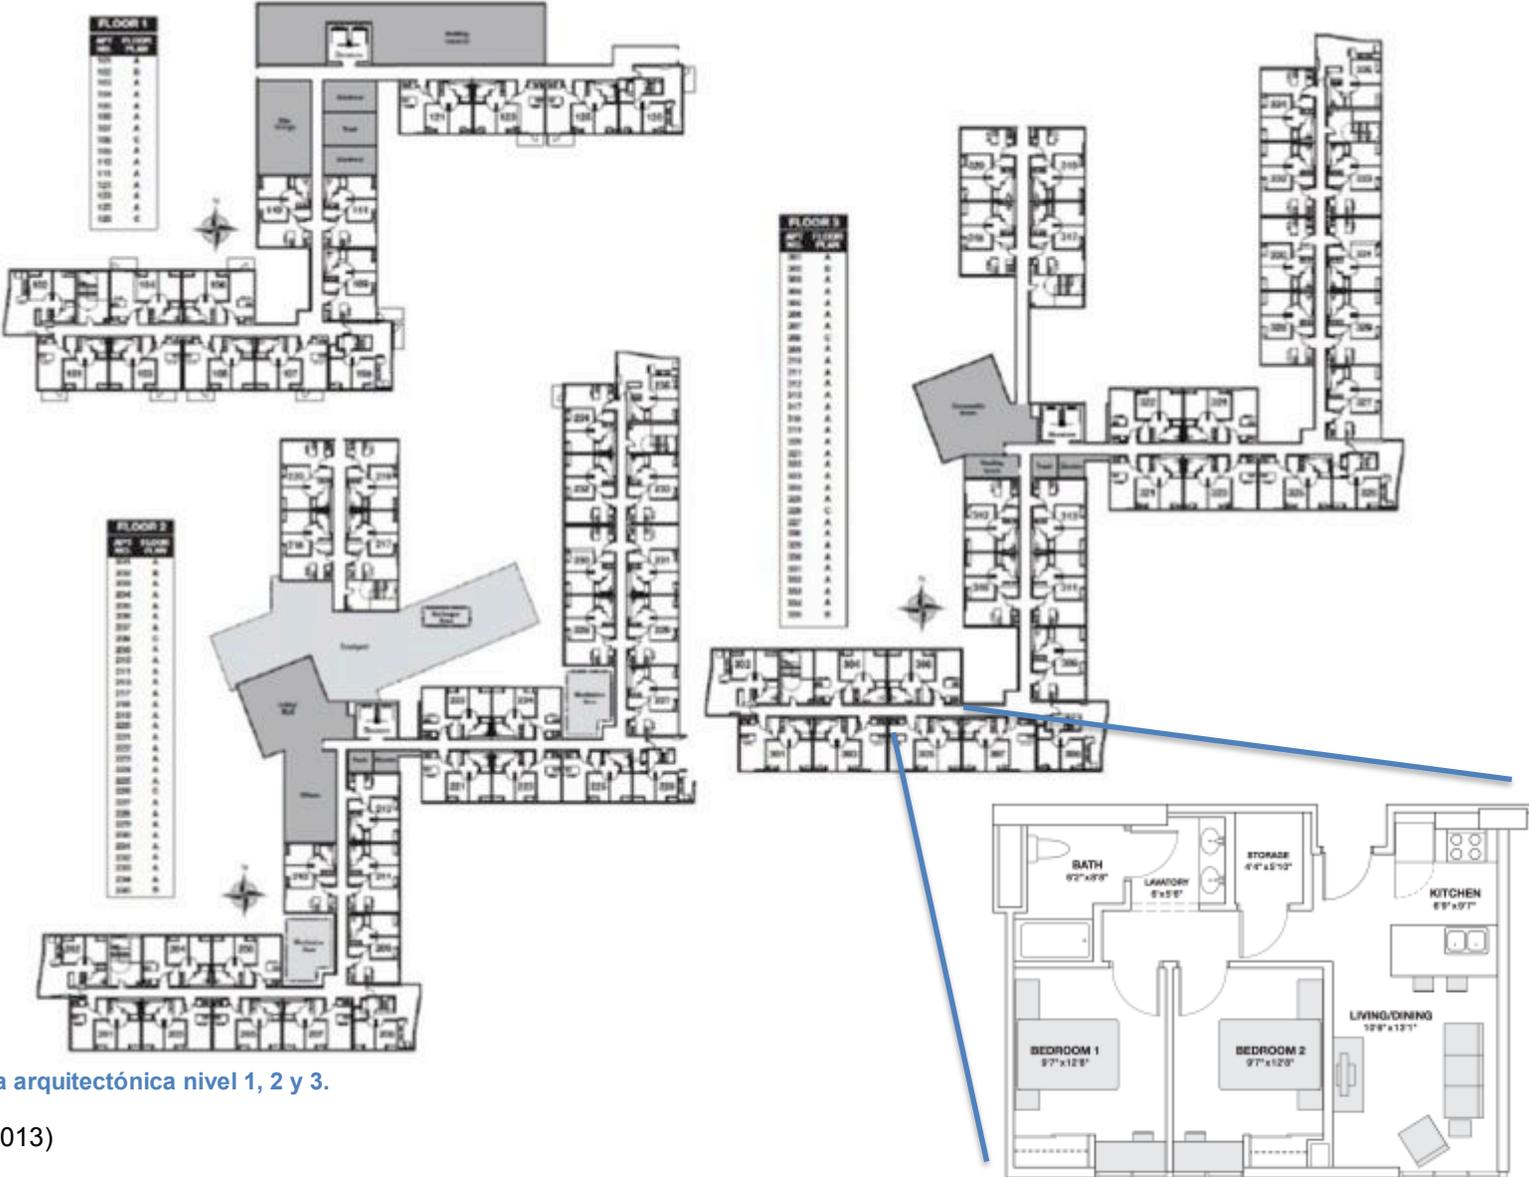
Planta arquitectónica nivel 1, 2 y 3.
